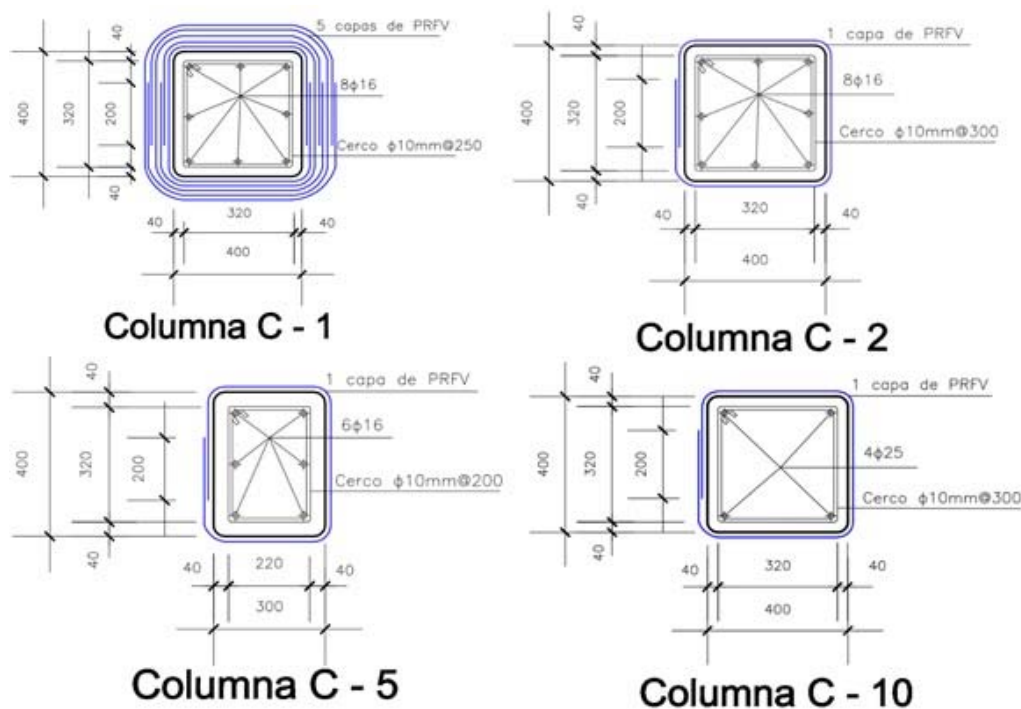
Esquemas y detalles de las columnas reforzadas con tejidos de PRFV.
